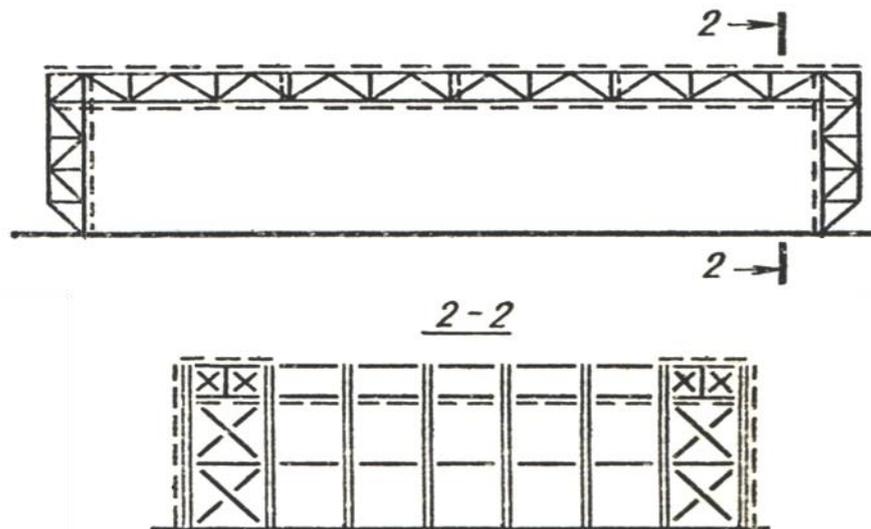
Система вертикальных и горизонтальных связей между рамами.
